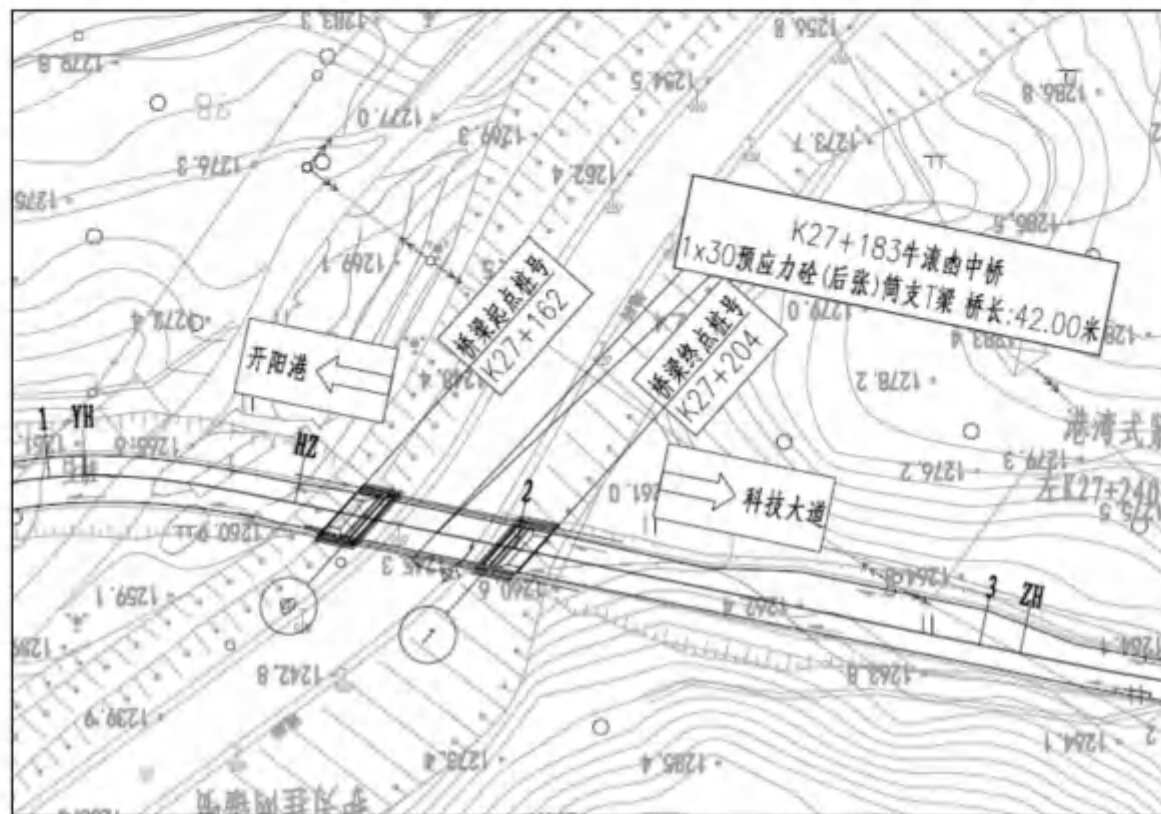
牛滚幽大桥桥位平面布置示意图
